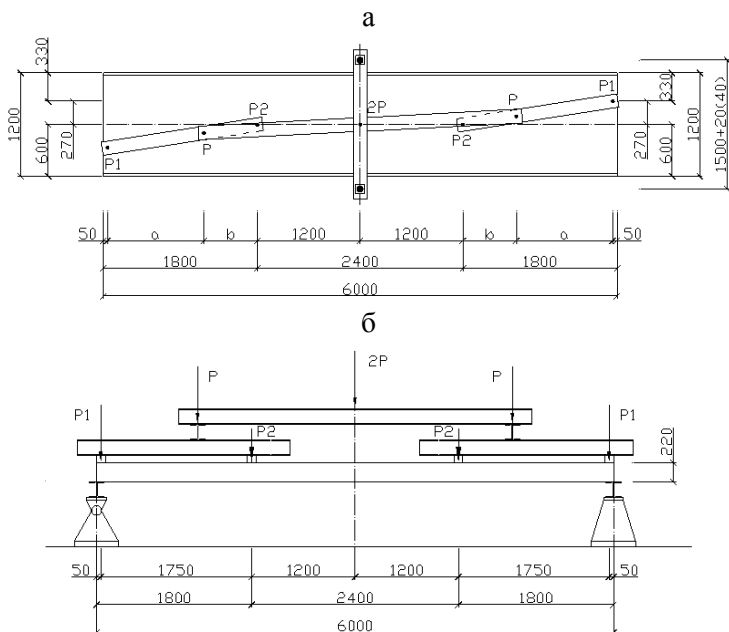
Установка для испытаний: а – вид сверху; б – вид сбоку
